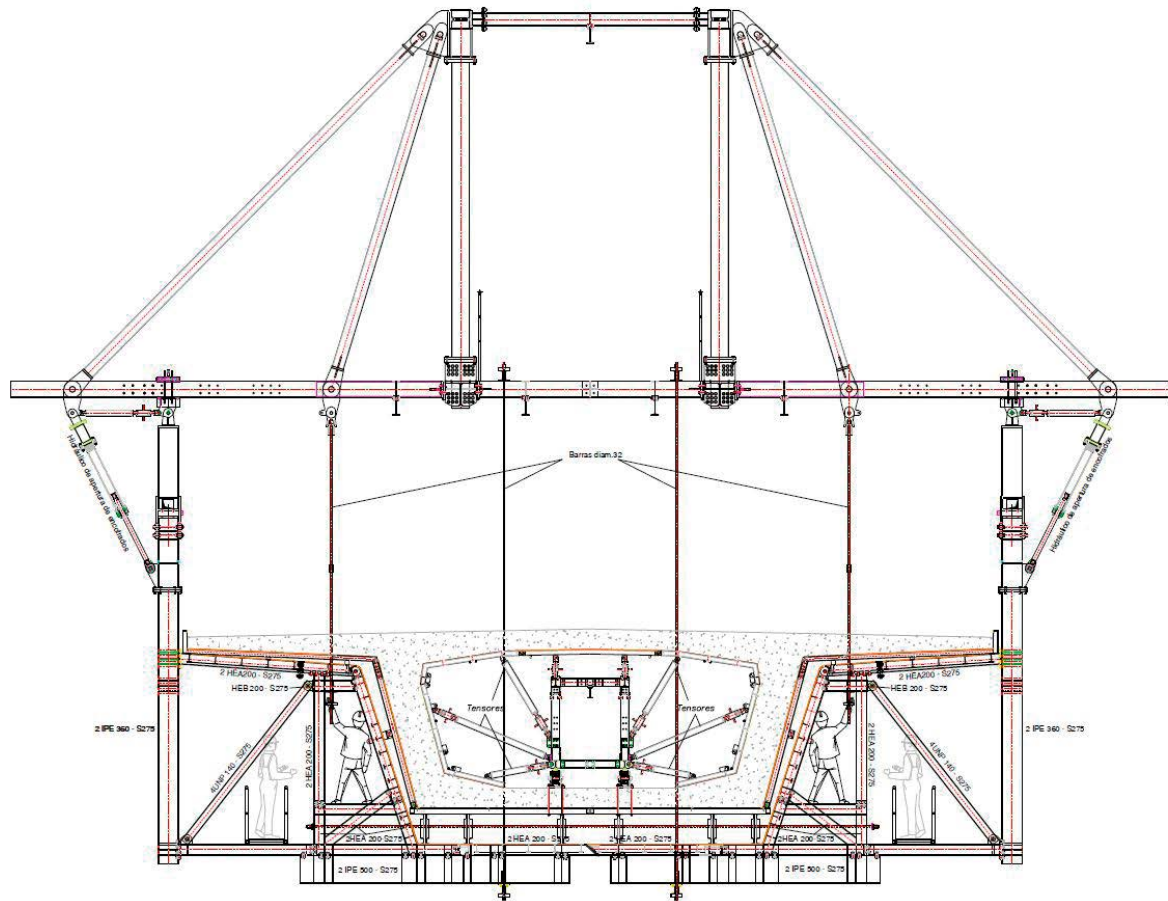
Croquis de la estructura soporte del encofrado de la autocimbra del margen norte.
